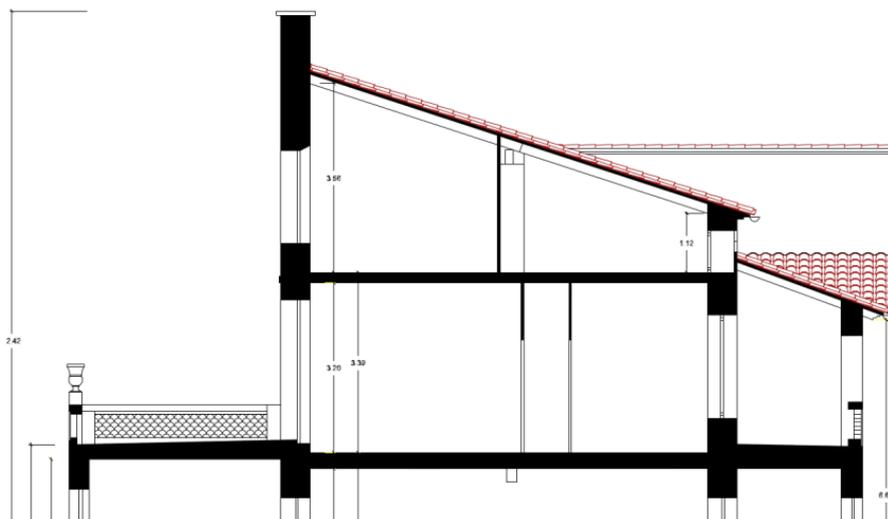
Plano de estructura de la cubierta. 2014. SANZ GUERRERO, V.
